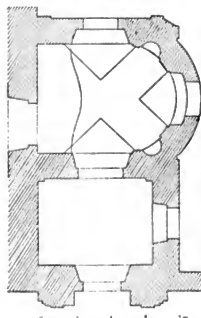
Koráb. Grundriss der Kapelle.
